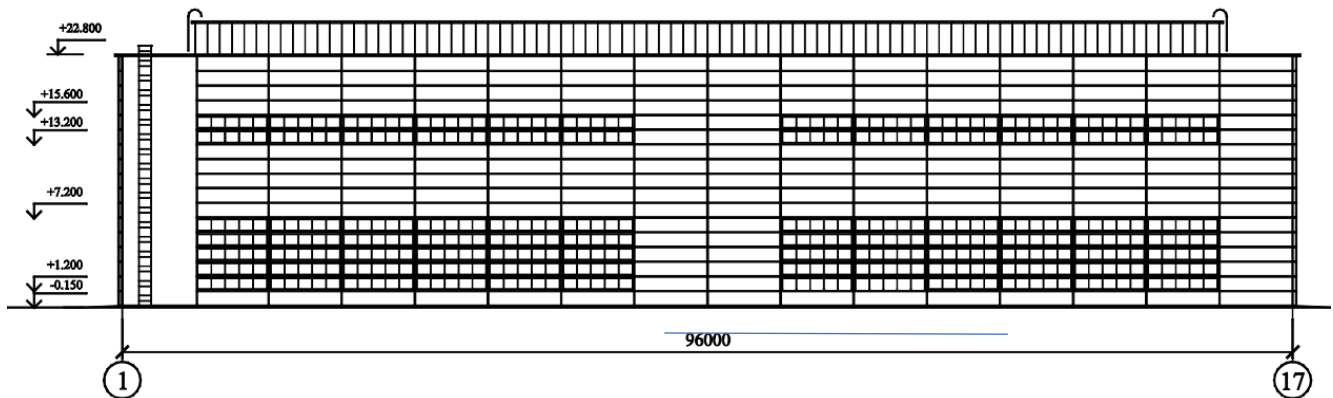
Схема розташування конструкцій огорожі фасаду 1-7
